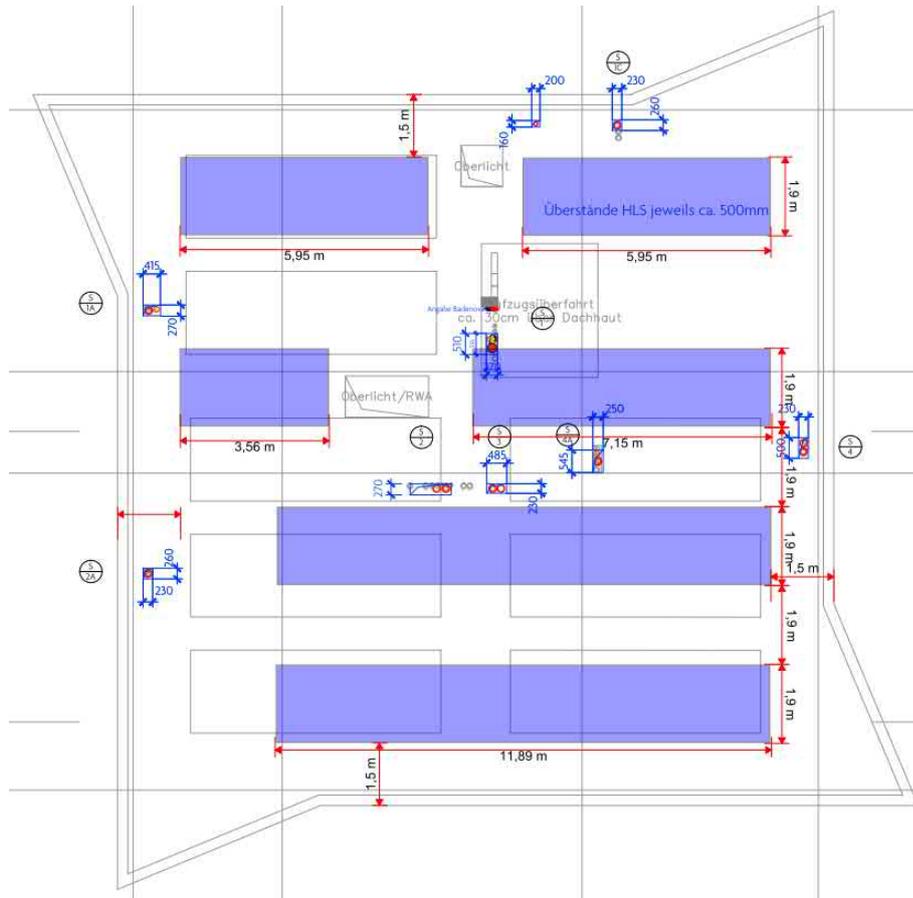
Dachaufsicht des 9-geschossigen Gebäudes mit Kollektorfeld
